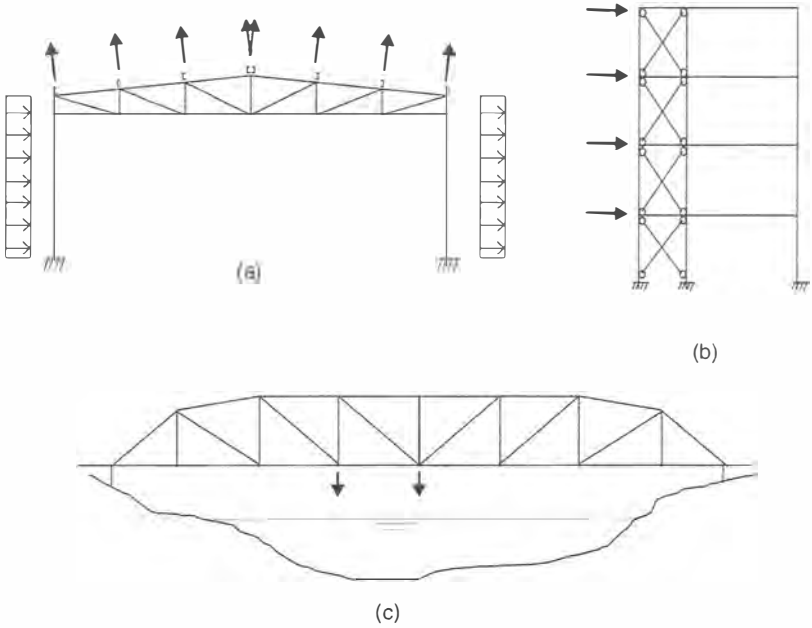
Aplicações de sistemas treliçados: coberturas de edificações industriais, contraventamentos de edifícios e pontes.
